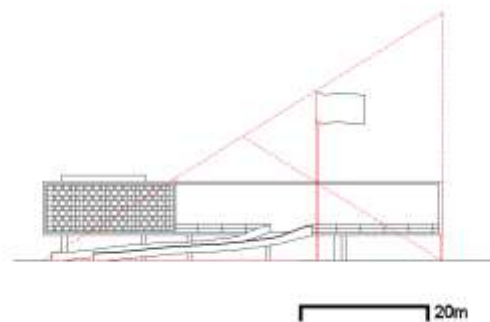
Elevação esquemática do pavilhão, proposta final, com traçado regulador (desenho do autor).
